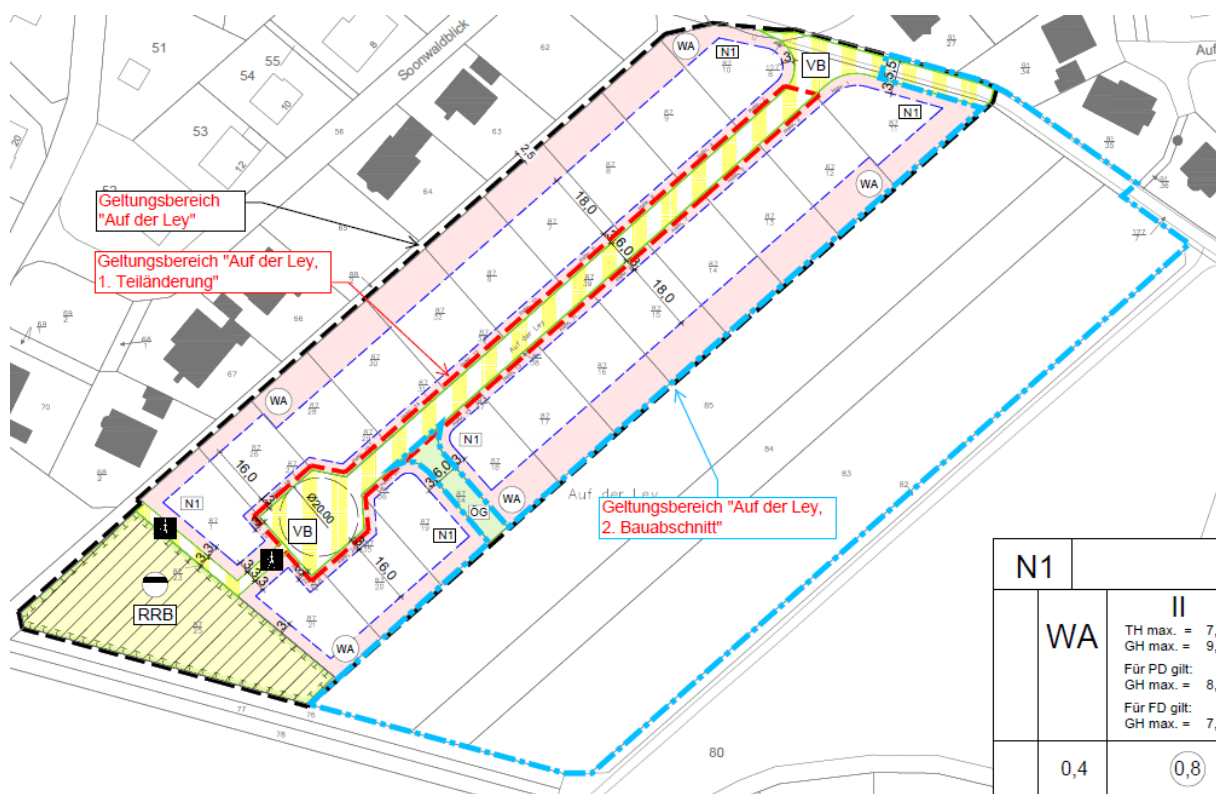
Auszug aus dem B-Plan Monzingen Auf der Ley, 1. Teiländerung mit Überlagerung der Geltungsbereiche B-Plan „Auf der Ley“ und „Auf der Ley, 2 Bauabschnitt“
